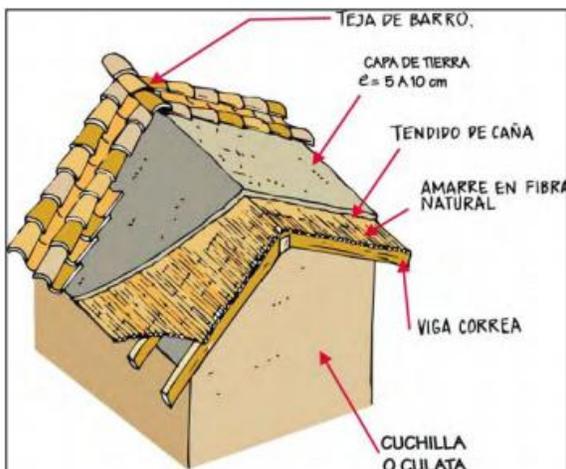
Cubierta de techo con bambú, barro y teja.
